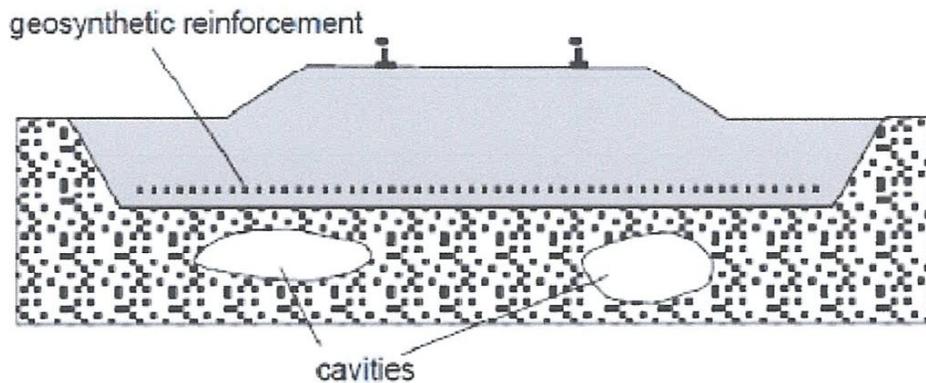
Remblai renforcé à une fondation de sol instable. [Ennio M. Palmeira, 2008]
